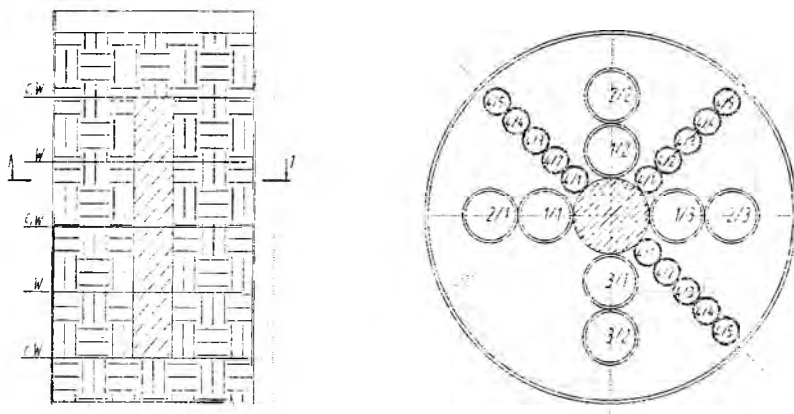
Схема расположения отбираемых образцов грунта в плане:
